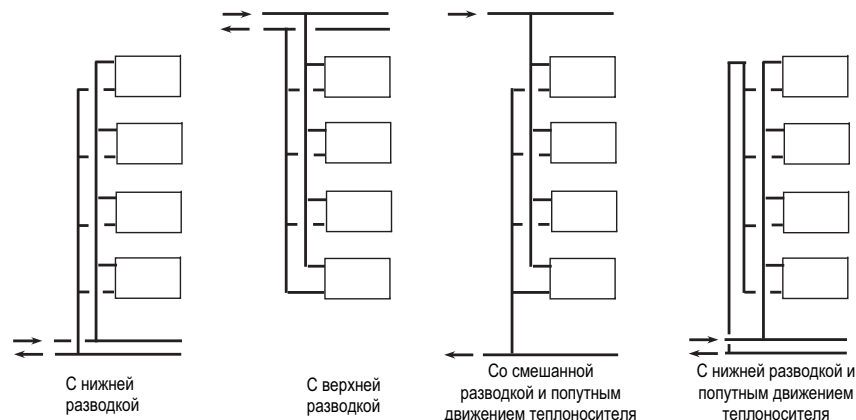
Схемы размещения магистральных трубопроводов вертикальных систем отопления
